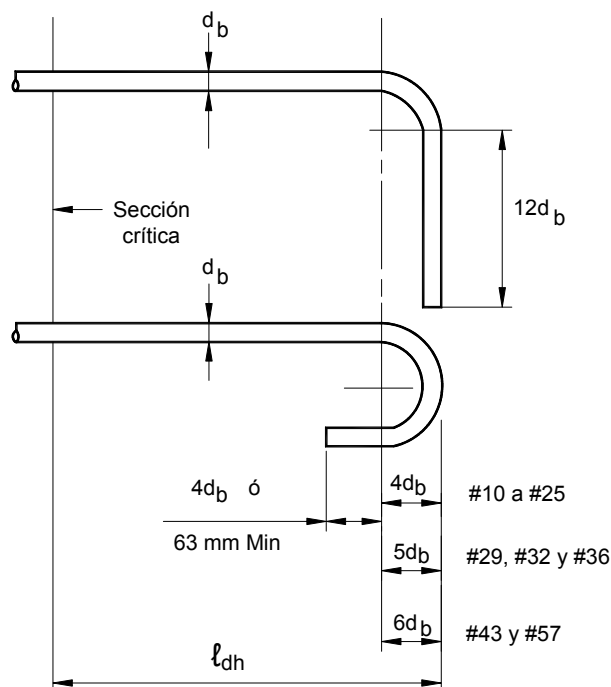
Detalles de las barras terminadas en gancho para el anclaje de ganchos normales (ACI)
